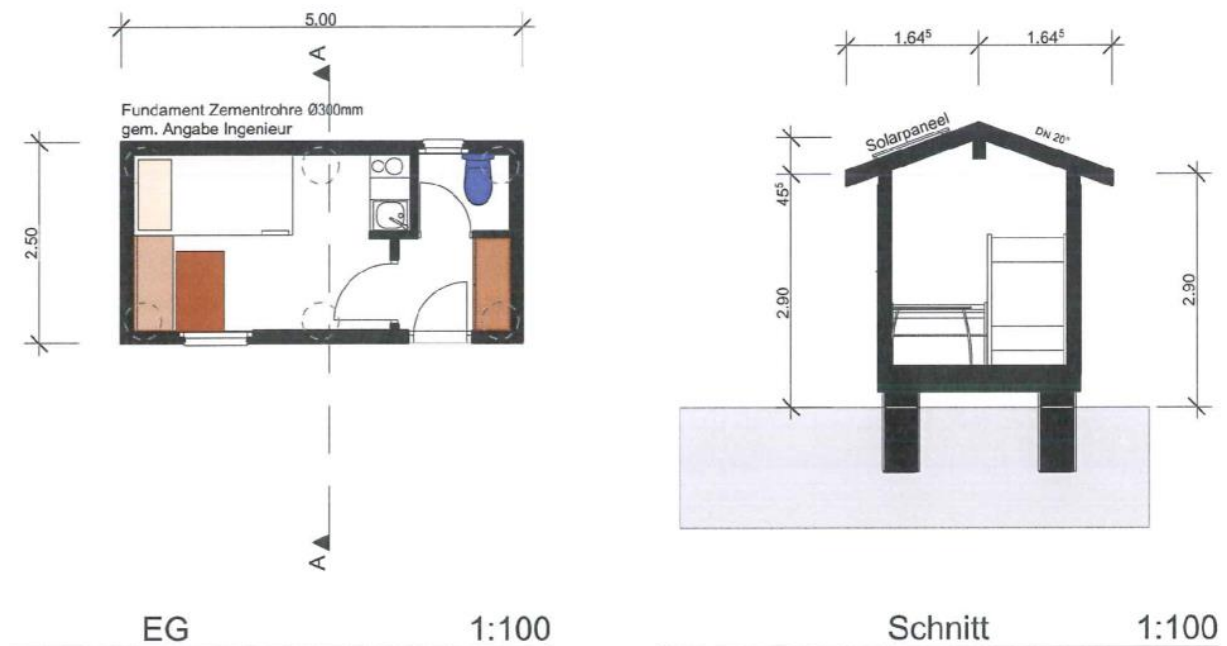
Grundriss und Seitenansicht Typ Raggi Quelle: (AGRIDEA 2018a)
